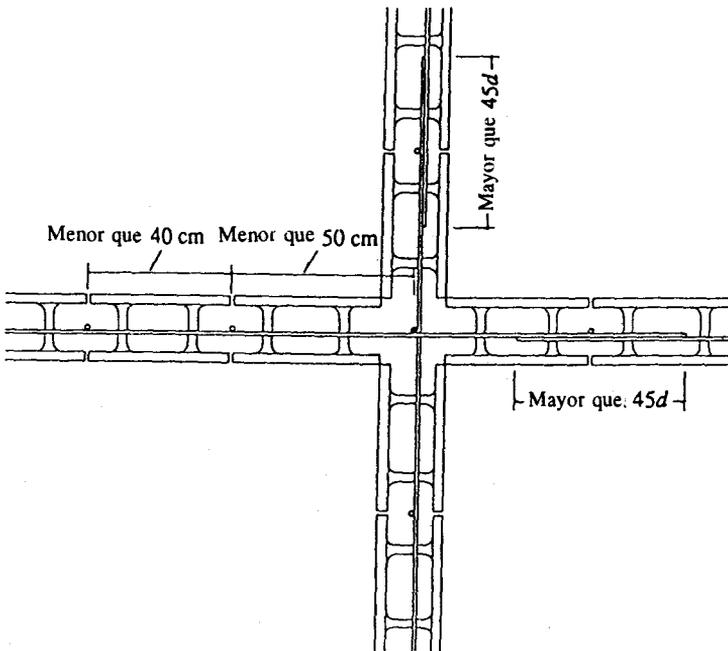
(a). Detalles de la Norma de refuerzo en una sección transversal horizontal de muros de cortante
